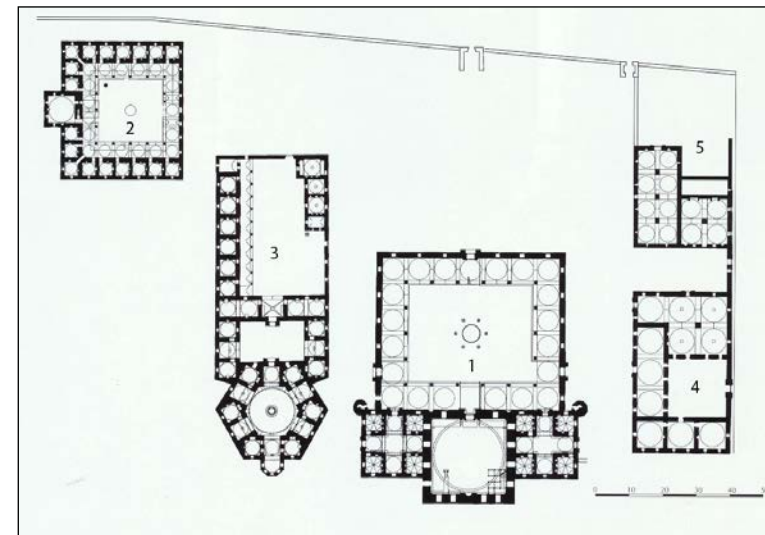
Beyazit Komplex, Edirne, Grundriss der Anlage
